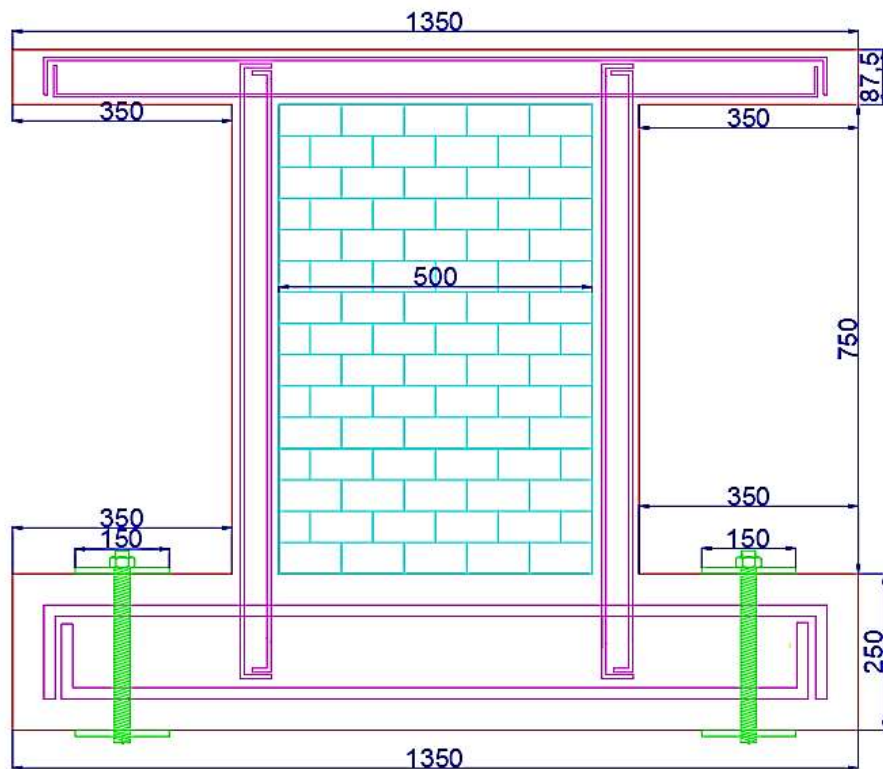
Pórtico de hormigón de 50cm x 75cm con relleno.
